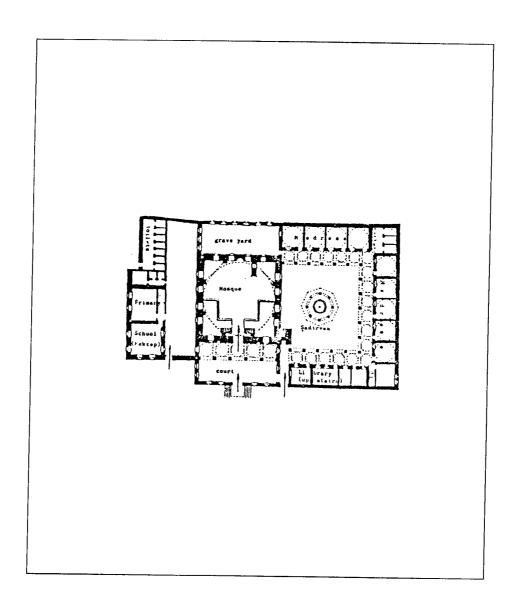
مسقط أفقي لمسجد نور عثمانية في إستانبول (عن : جودوين) .
